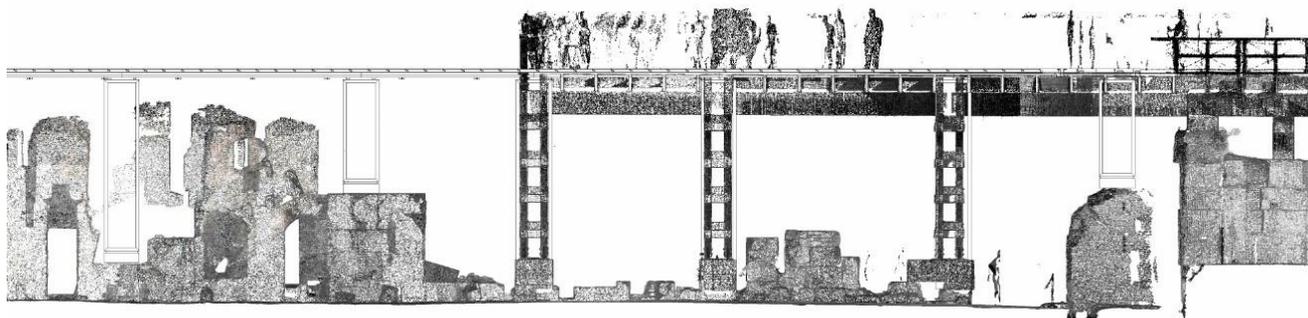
Sezione di confronto da BIM tra piano esistente e piano di progetto
